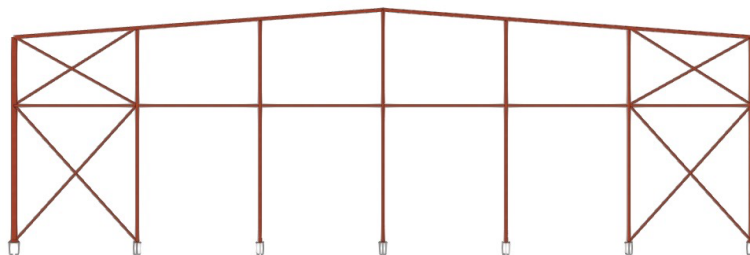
Pórtico de fachada (1 y 16). CYPE Ingenieros.
